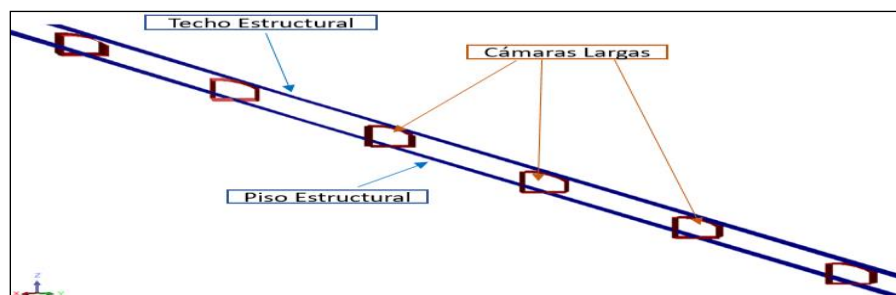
Sección cámaras largas, perfil de la labor delimitada por estructural de piso y techo.
